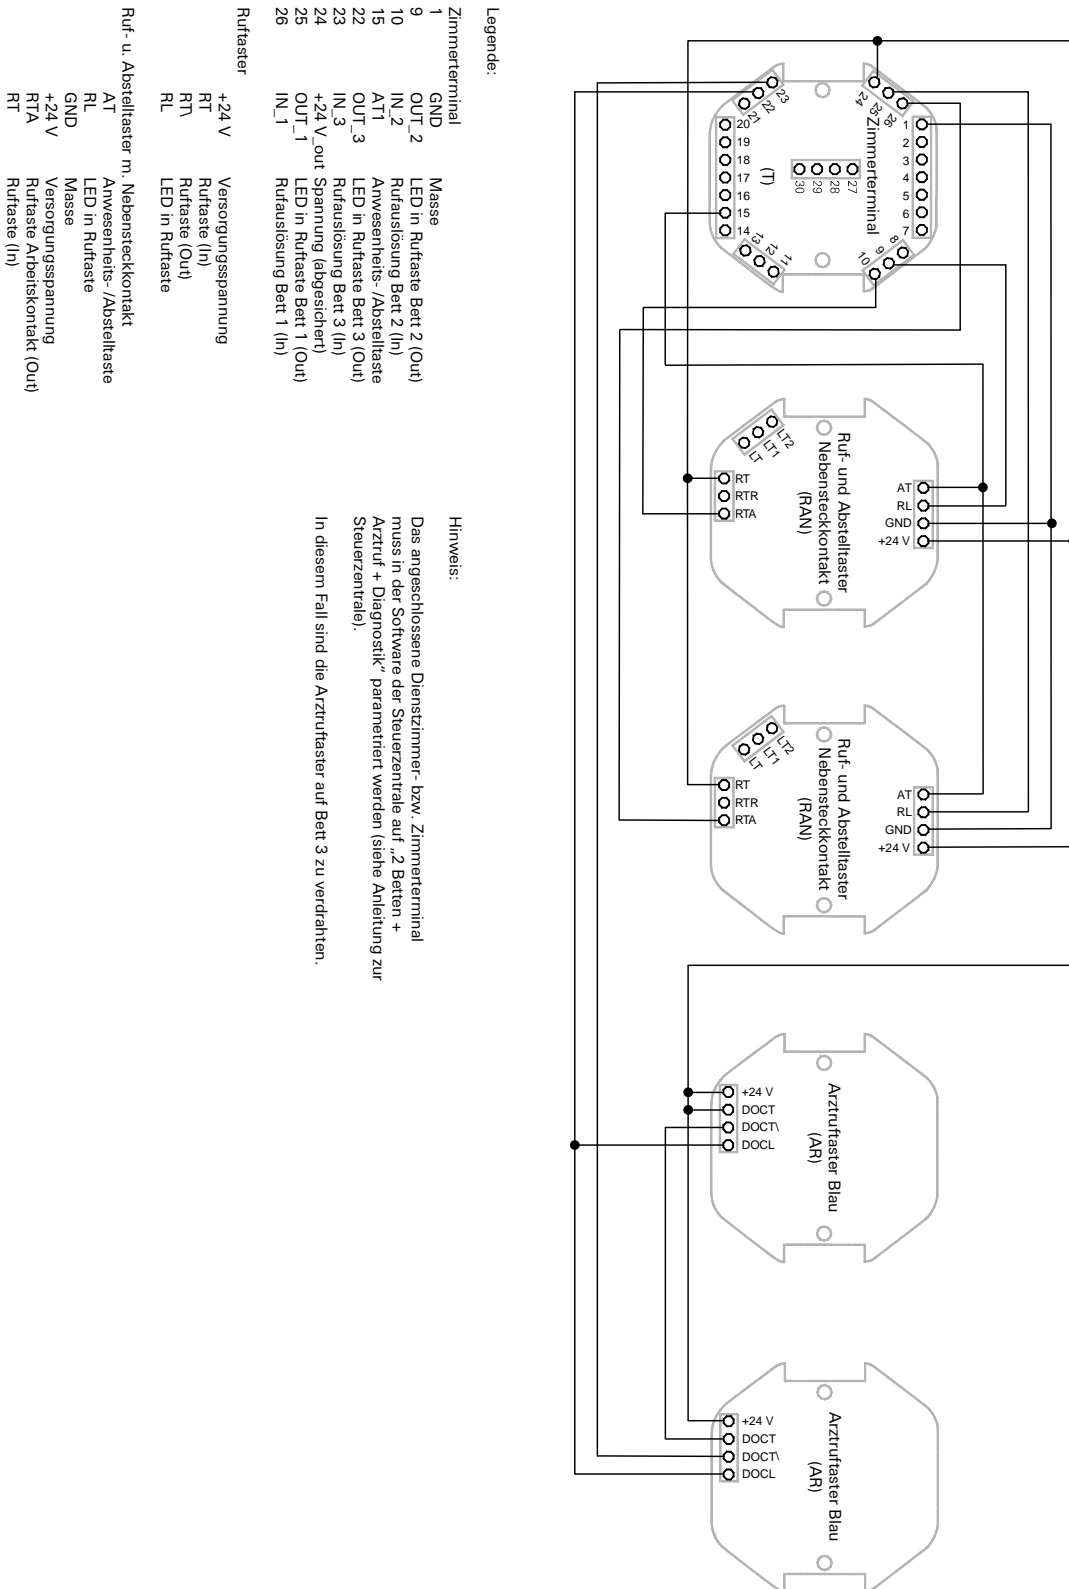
Verdrahtung in einem Zweibettzimmer mit AR, RAN und T mit Bettenkennung (Beispiel 4)
